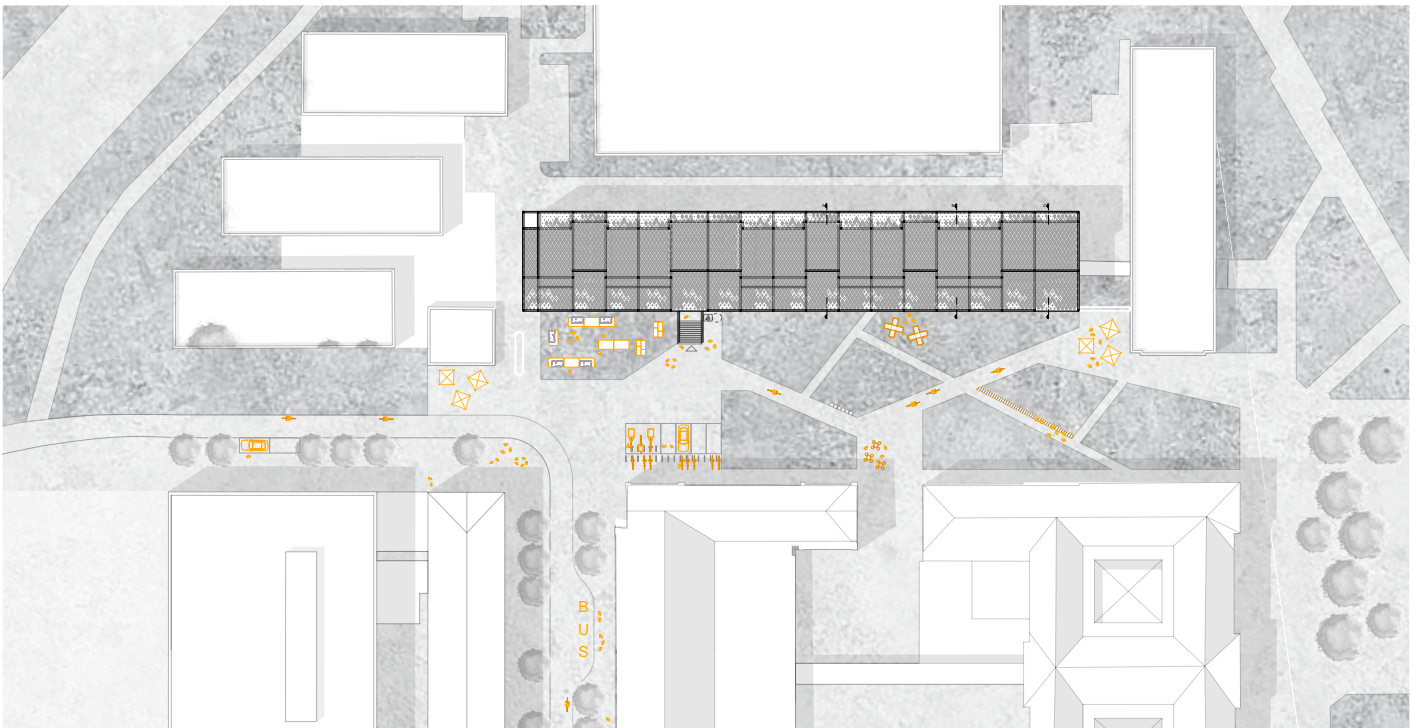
Dachaufsicht und Umgebung HFT Campus
